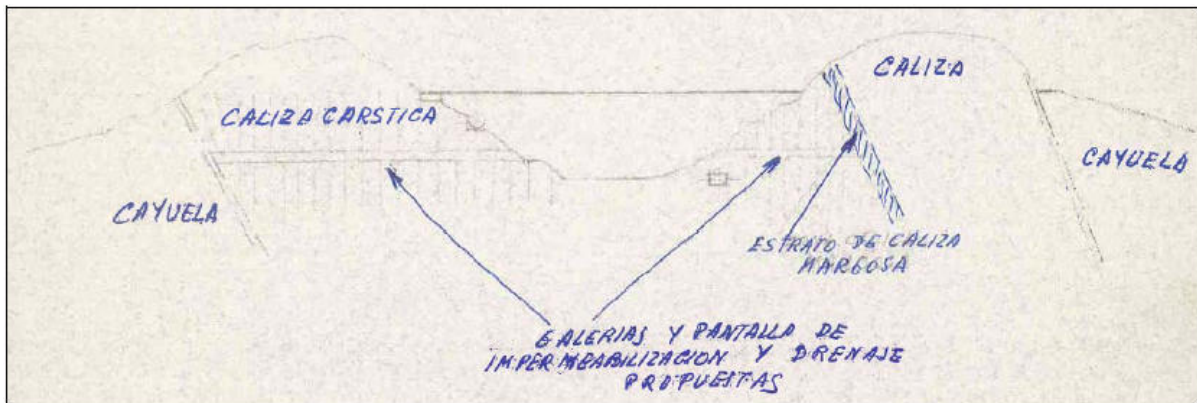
Corte (S-N) de la presa y galerías de drenaje
